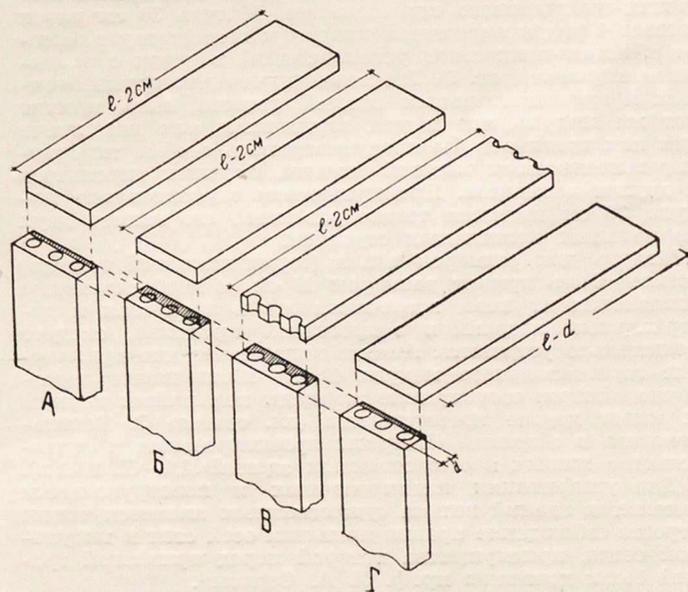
Схема опирания железобетонных настилов на внутренние стены (по каталогам)
